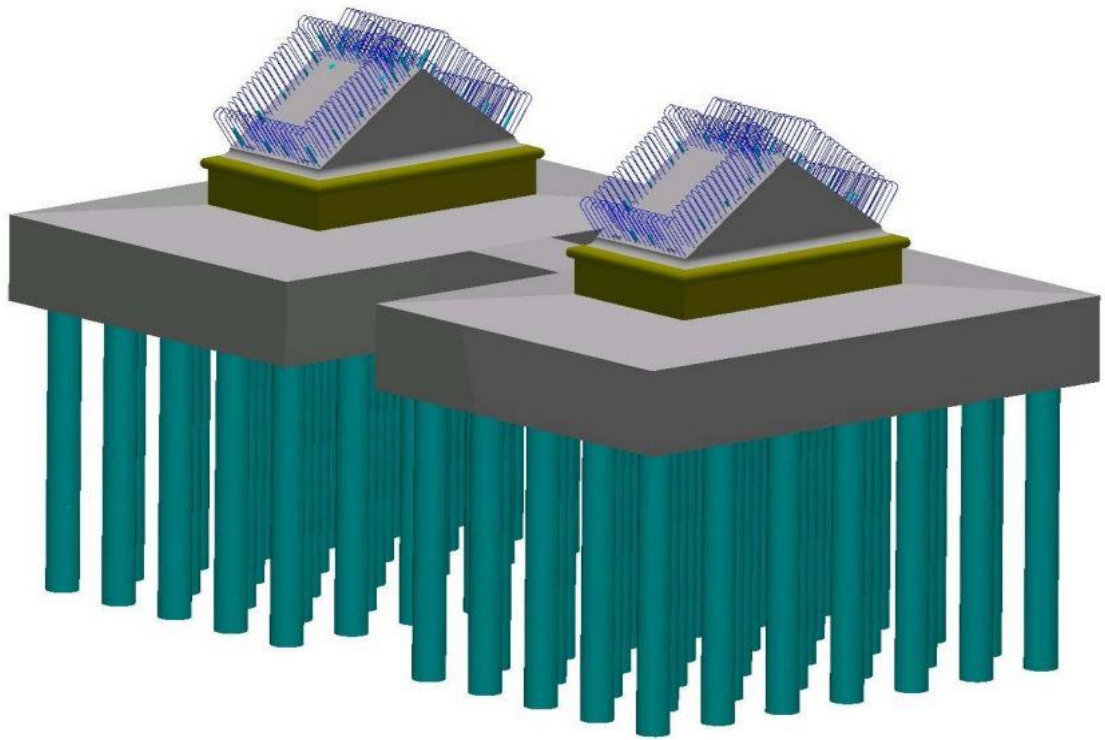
42 Woodrow Wilson Memorial Bridge 基礎 3D 模型
